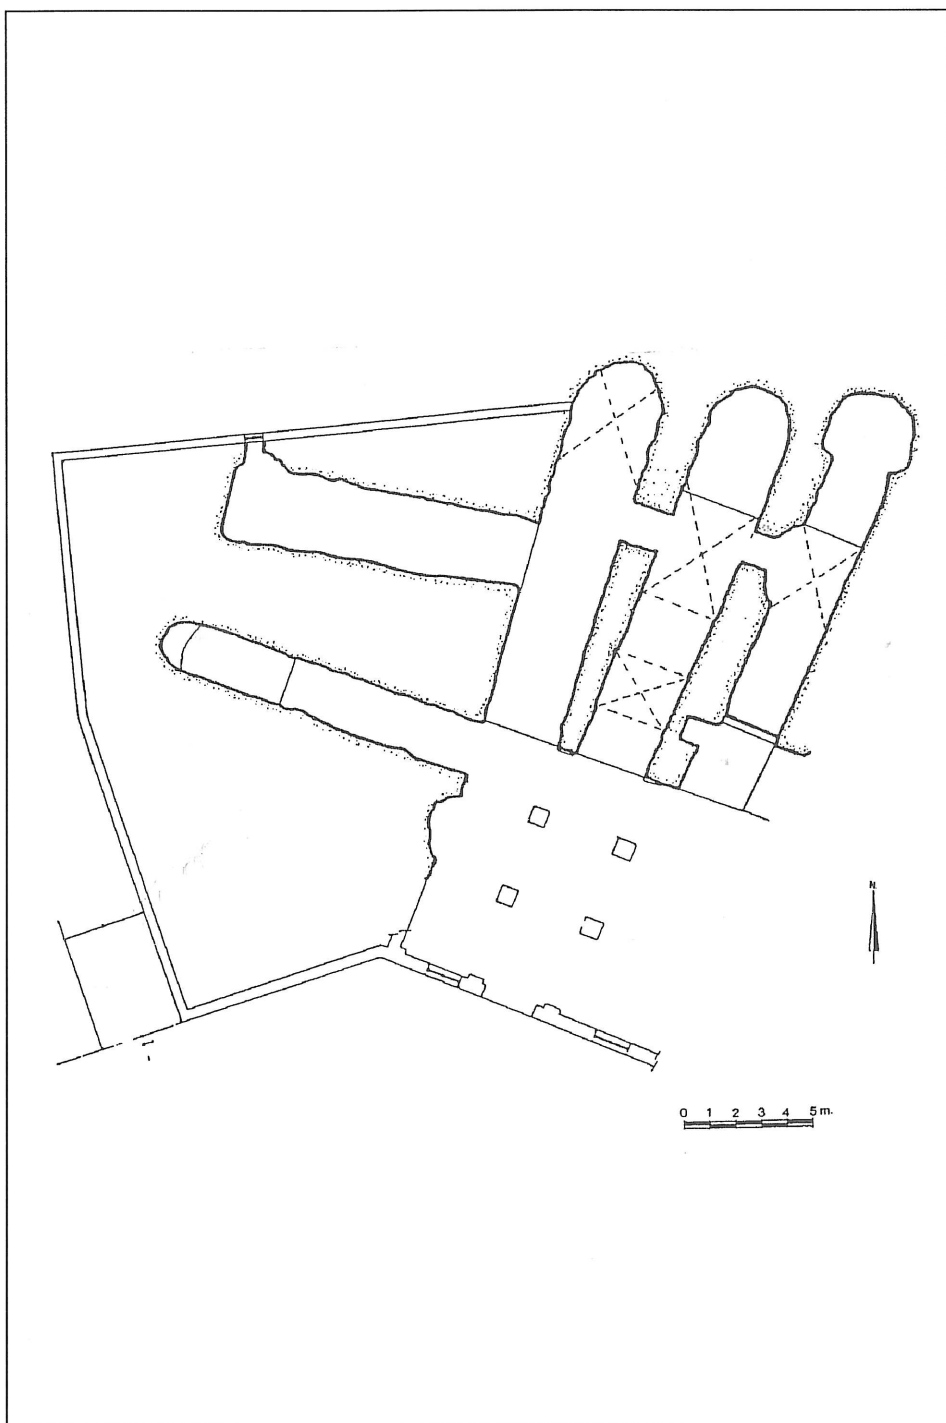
Conjunto rupestre de Archidona (Málaga). Planta (según: Puertas Tricas)
